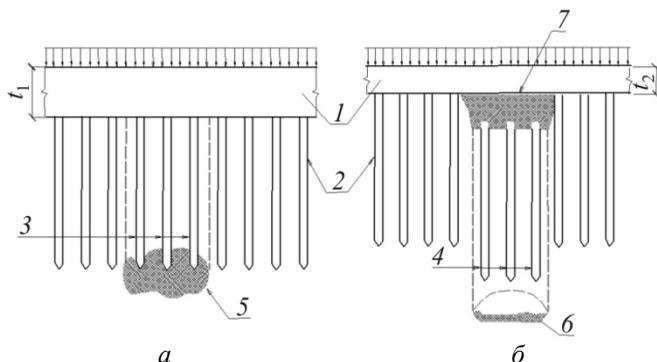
Конструкция свайных фундаментов (СП 499.1325800): *а* – жесткое сопряжение свай и плиты ростверка высотой  $t_1$ ; *б* – свободное соединение свай и плиты ростверка высотой  $t_2(t_2 < t_1)$ ; 1 – плита; 2 – сваи; 3 – сваи, зависшие над полостью с налипшим на них грунтом; 4 – сваи, свободно выпавшие из ростверка после образования под ними провала; 5 – карстовая полость; 6 – обрушенная карстовая полость; 7 – провал под ростверком
